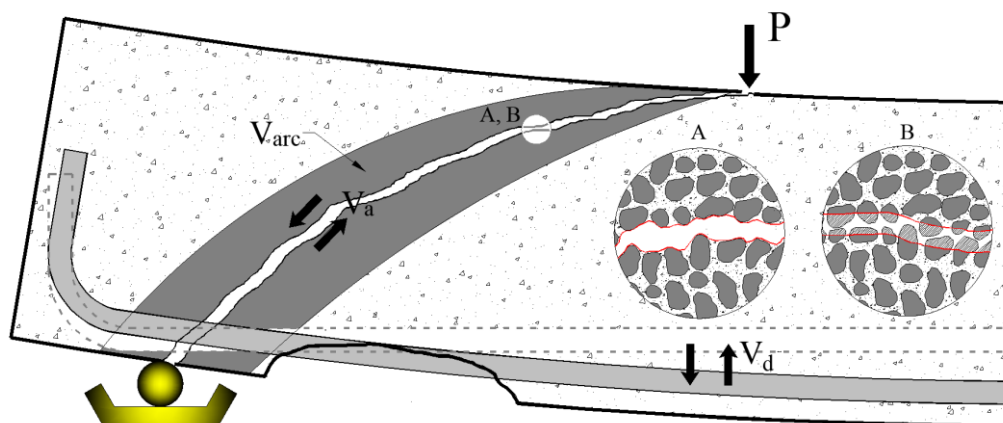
Transferência de esforços pós-fissuração.
